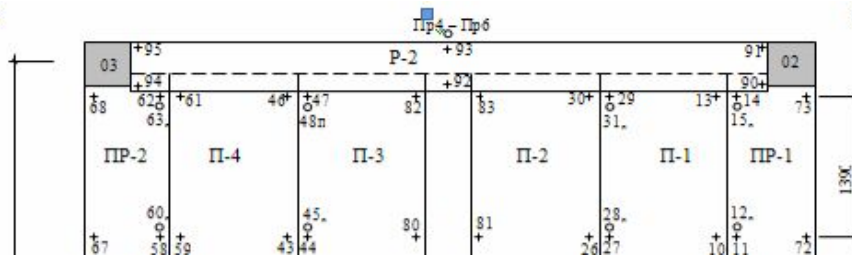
Схема расстановки приборов по низу фрагмента перекрытия
